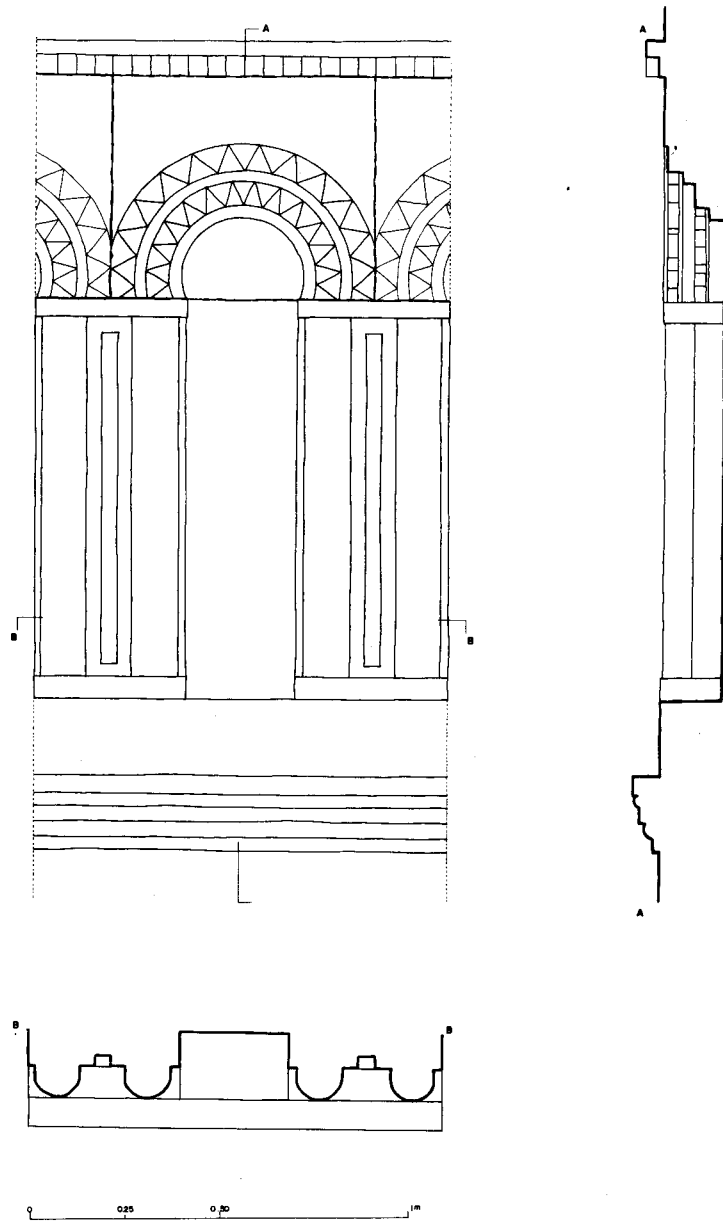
Planta, alzado y sección de detalle de los arcos ciegos.
